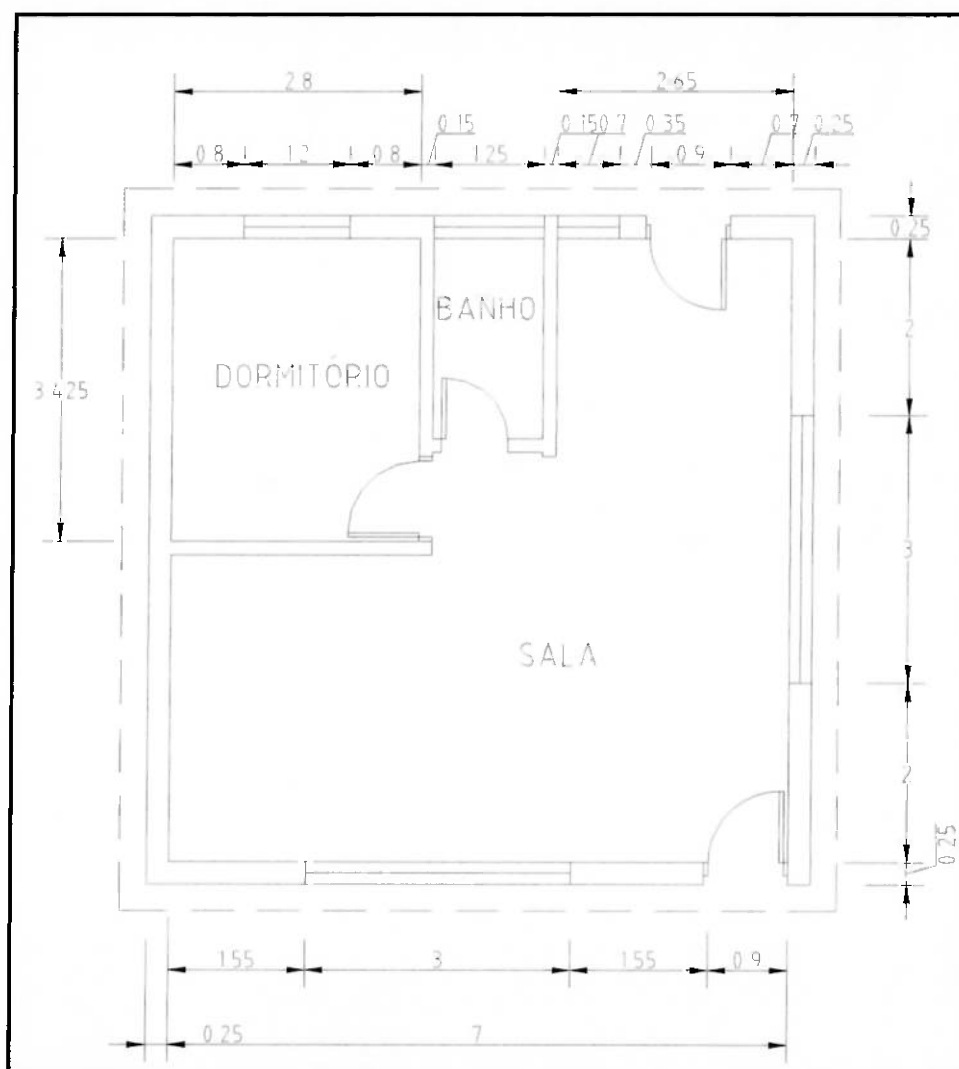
Planta baixa do Protótipo Residencial. AKUTSU (1983).
